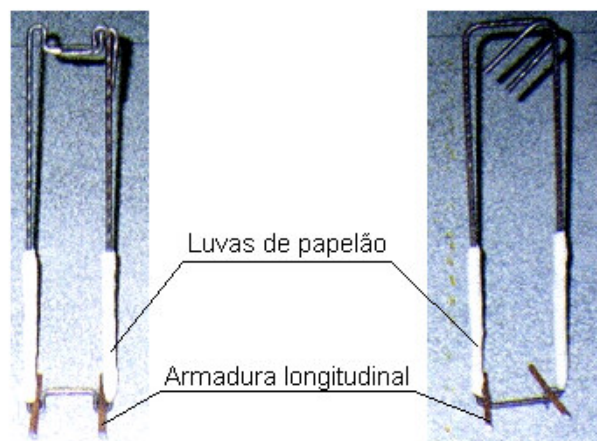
Detalhes das luvas e armaduras longitudinais
